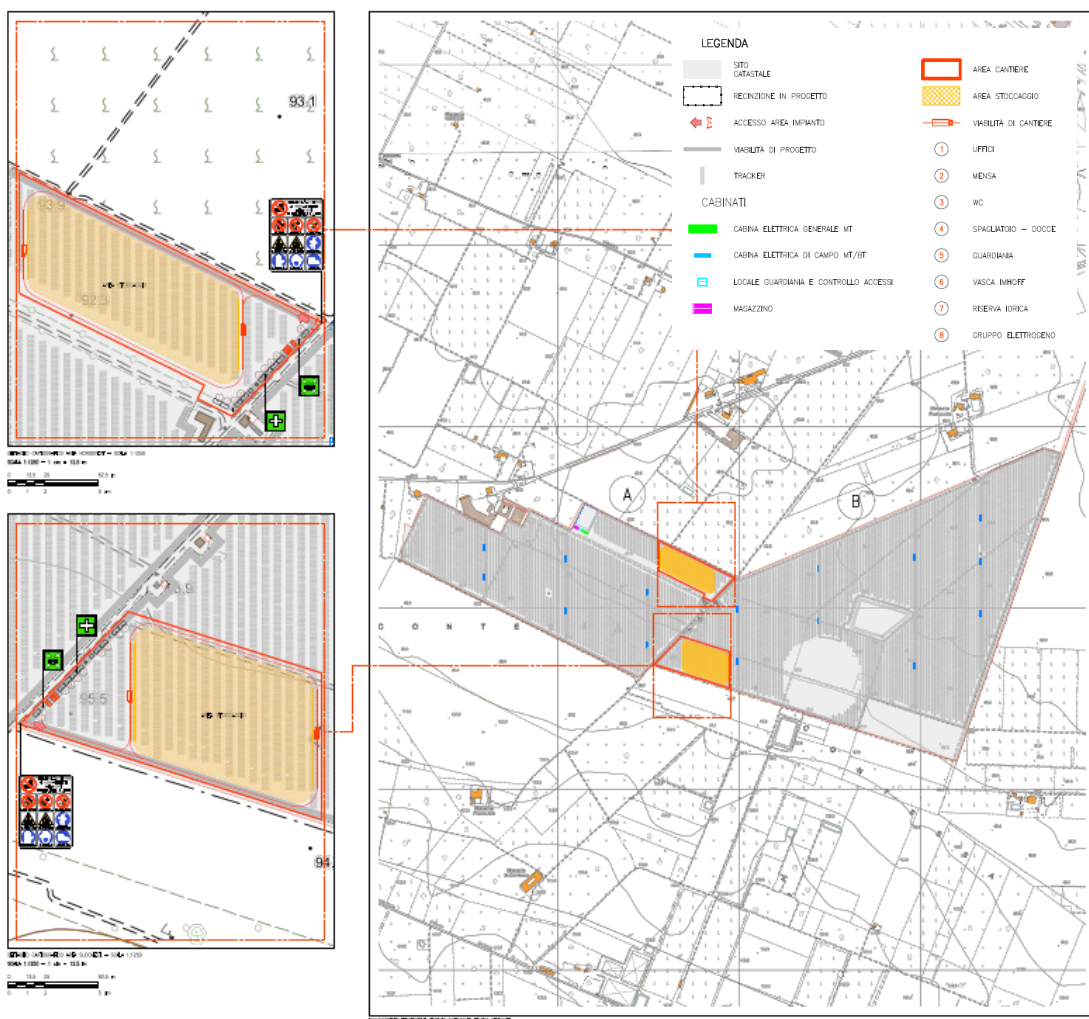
Aree di cantiere (costruzione e dimissione)
